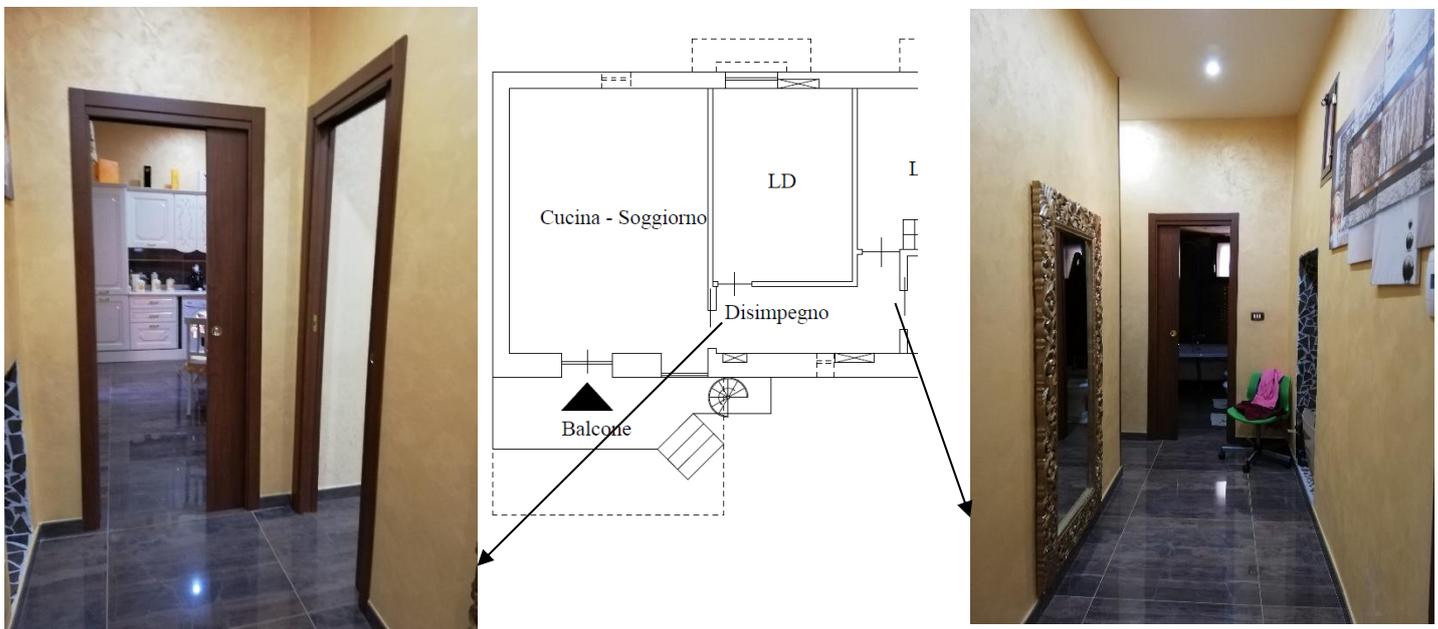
Individuazione fotografica degli interni del bene oggetto di pignoramento.
